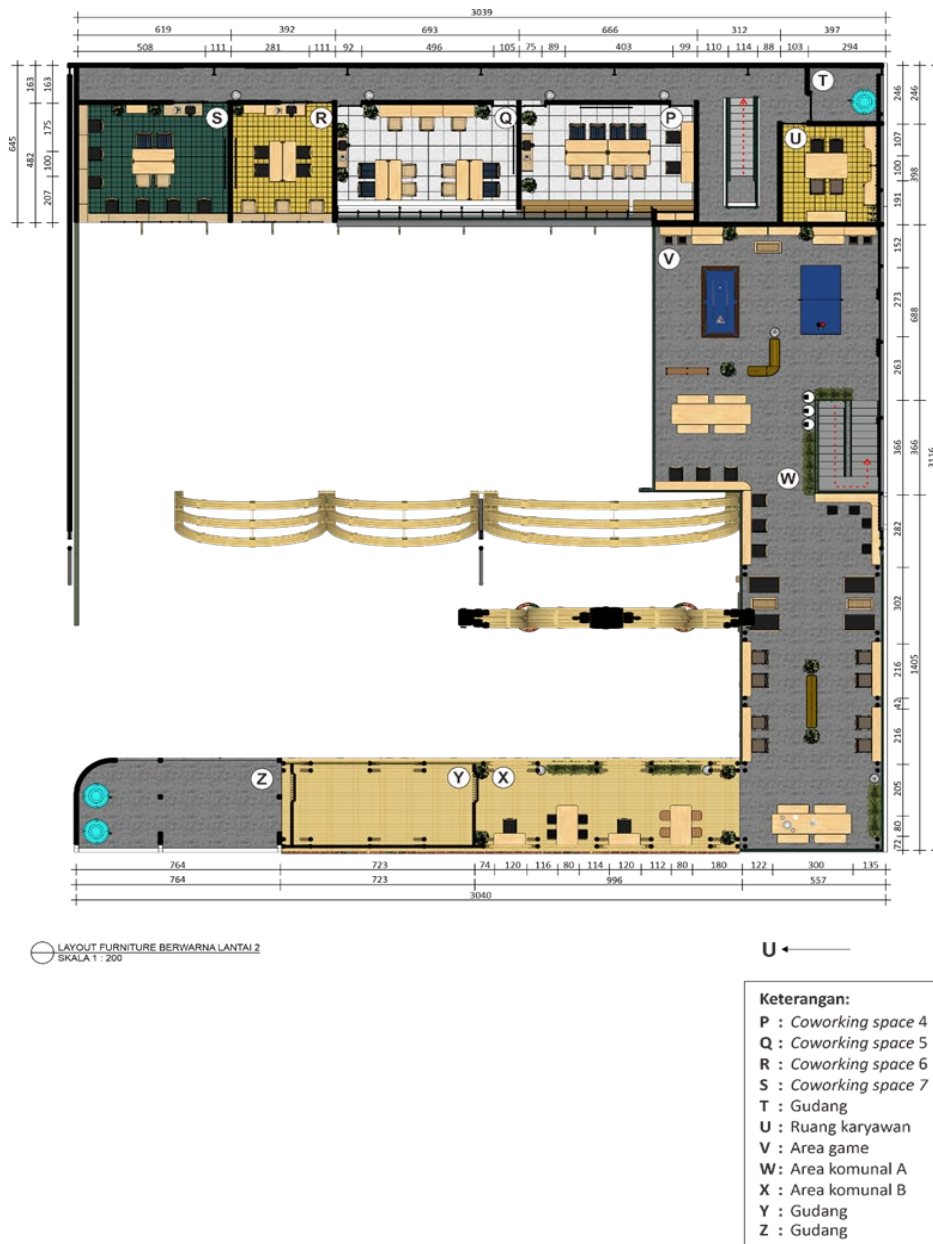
dan Gambar 2 berikut memperlihatkan keseluruhan denah dalam konsep media. Gambar 1 memperlihatkan denah lantai 1 yang terdiri dari 15 ruangan. Sementara itu, Gambar 2 memperlihatkan denah lantai 2 yang terdiri dari 11 ruangan. Total terdapat 26 ruang yang dianalisis dan dikonsepskan, yang terdiri dari entrance, ruang security, area parkir, resepsionis, area stage, area pantry, area komunal lantai 1, area seminar, ruang coworking space 1 - 7, dapur, toilet pria dan wanita, mushola, lorong lantai 2, area permainan, area komunal lantai 2, gudang, dan ruang penampung air.
